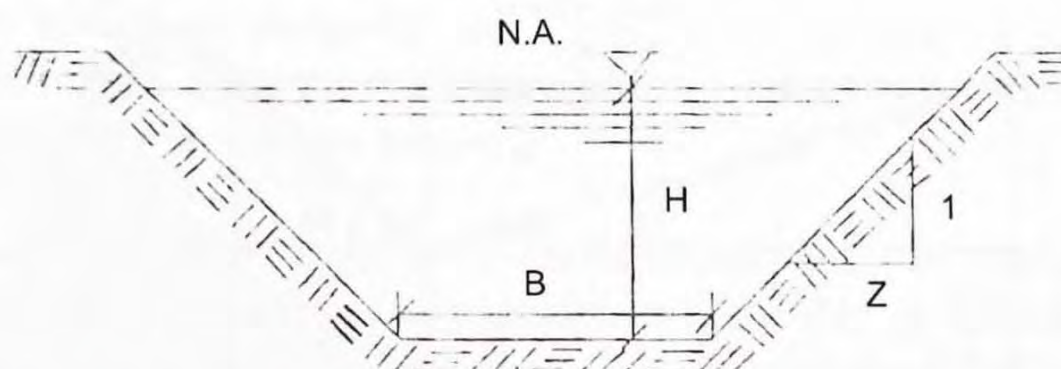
Representação esquemática de um terraço com secção transversal trapezoidal.
